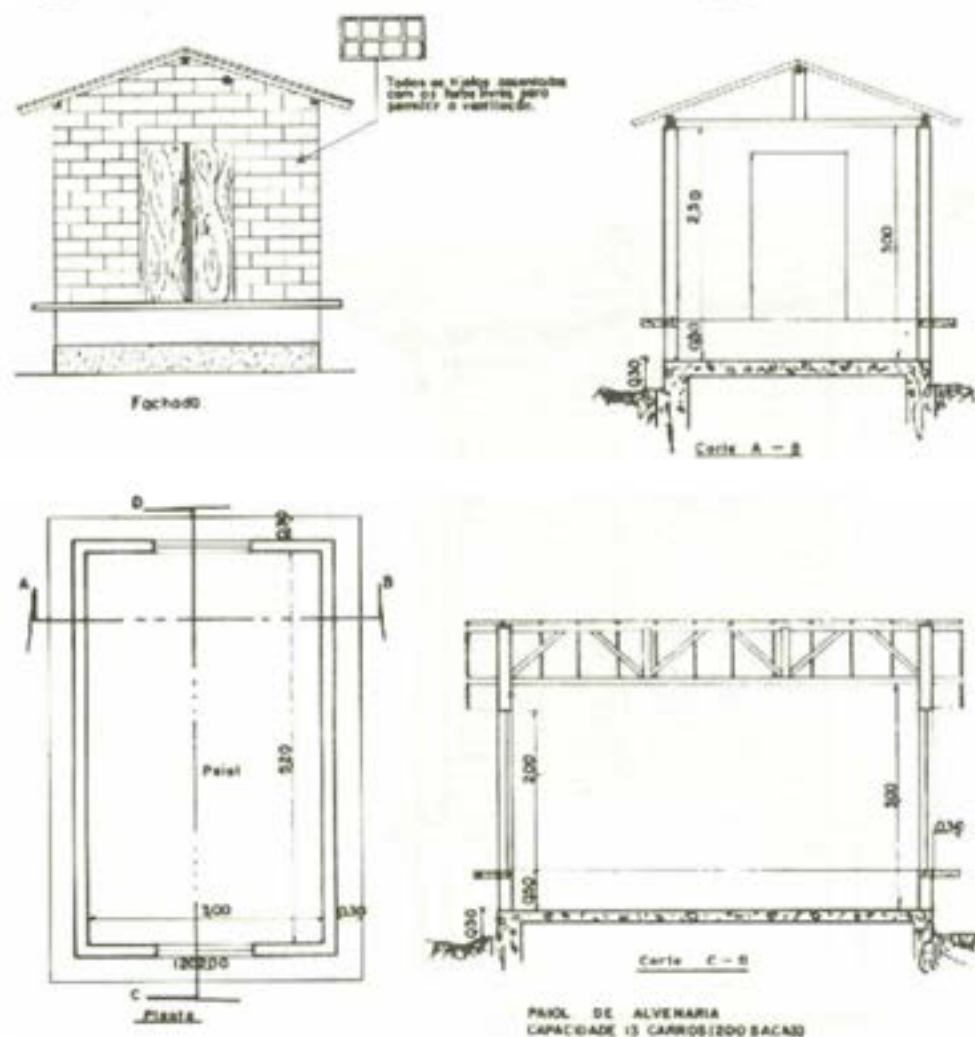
Paiol alvenaria (tijolo) e madeira. Ao lado, paiol constituído de 4 pilastras de alvenaria de tijolos; pilastras e pés direitos de madeira; cobertura de telha tipo francesa e piso de terra comprimida entre paredes de alvenaria. Fonte: [7].
